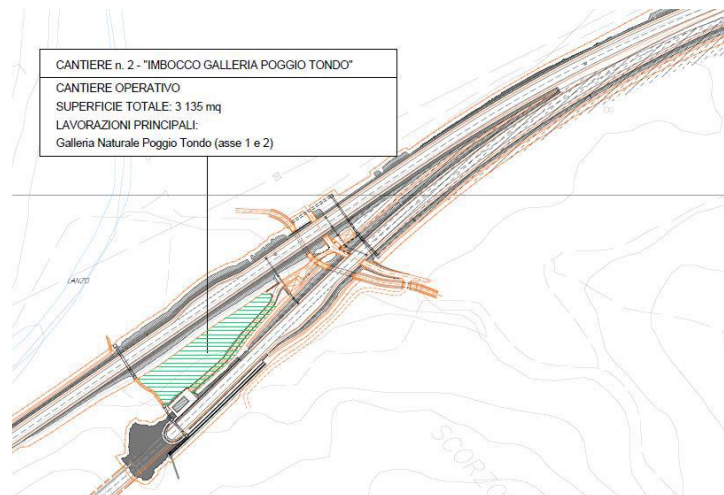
Estratto Area di cantiere n.2 "Poggio Tondo" (in verde)
